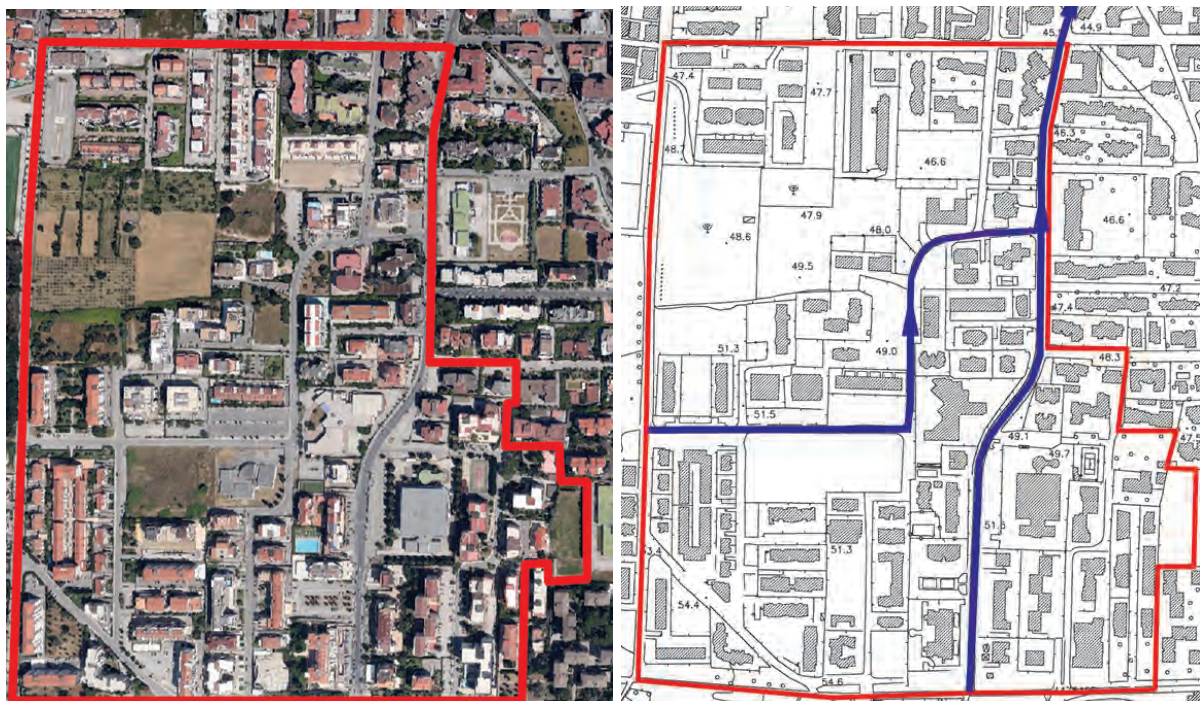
| Aversa periferia sud-ovest: ortofoto (sx) e planimetria della rete fognaria (dx) rappresentata con la linea blu.
